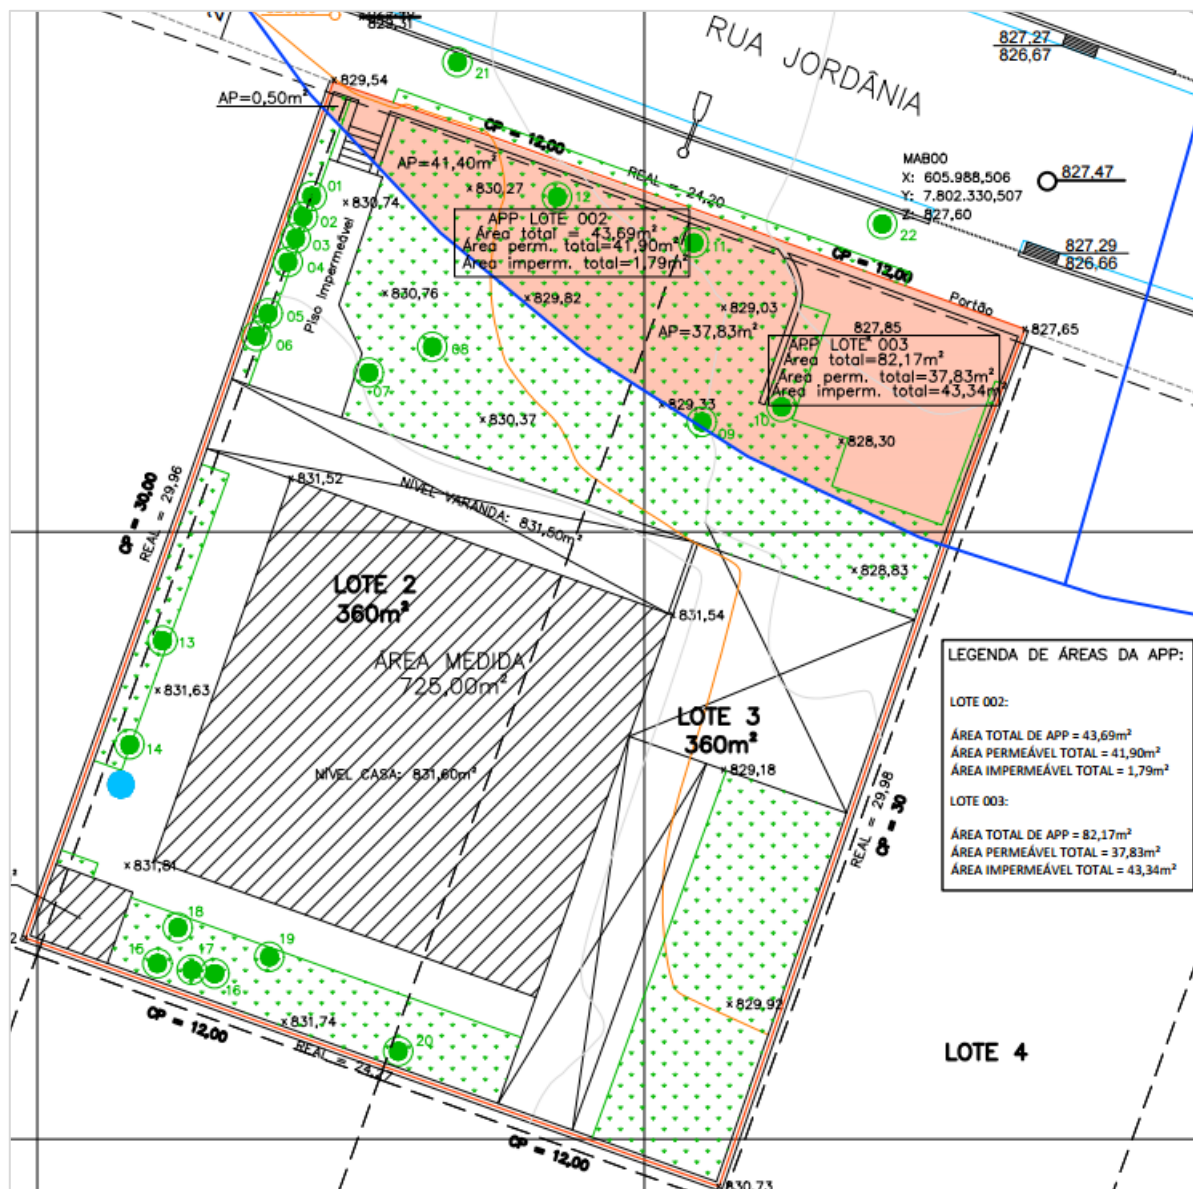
Recorte planta planialtimétrica com indicação da APP.
